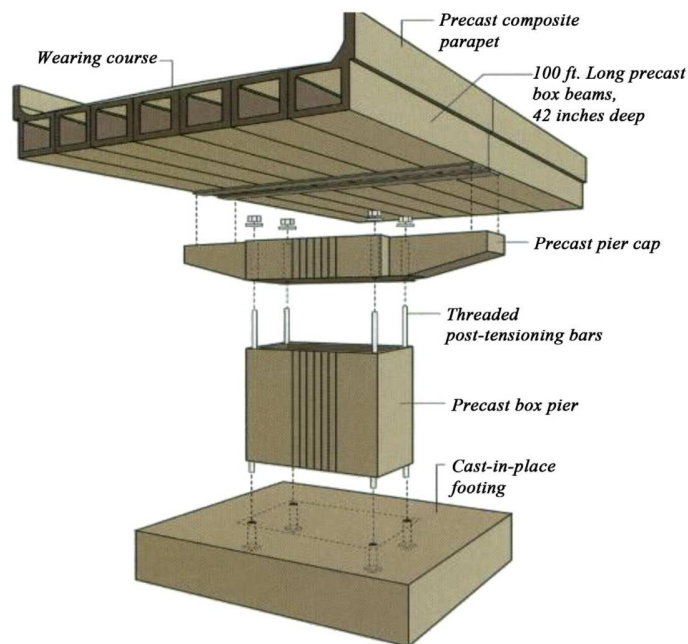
Esquema de sistema de puente prefabricado*⁵
